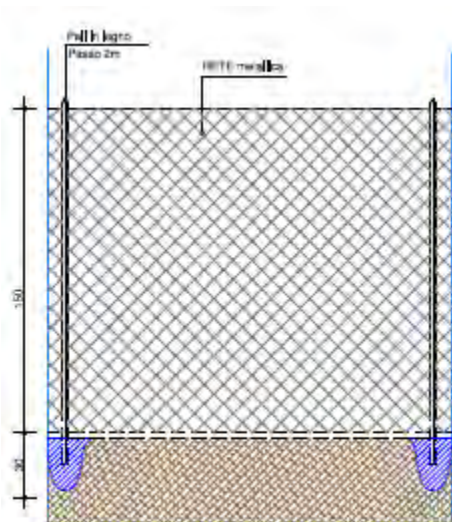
Estratto tav. di progetto - PROSPETTO RECINZIONE DI PROGETTO
